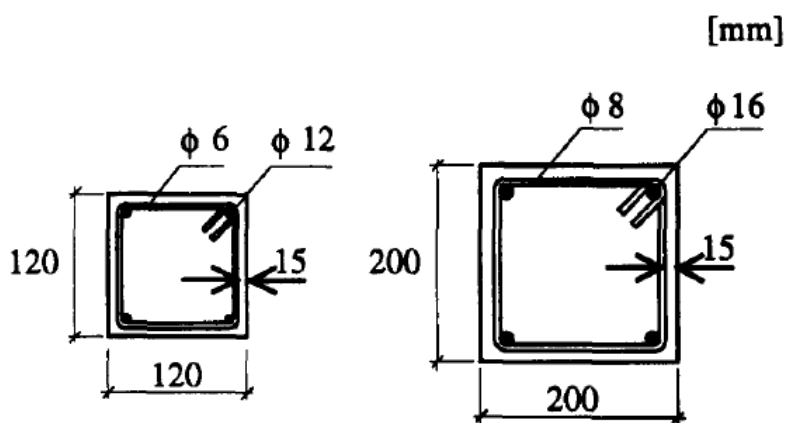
Seções transversais dos pilares de Claeson e Gylltoft (1998)
